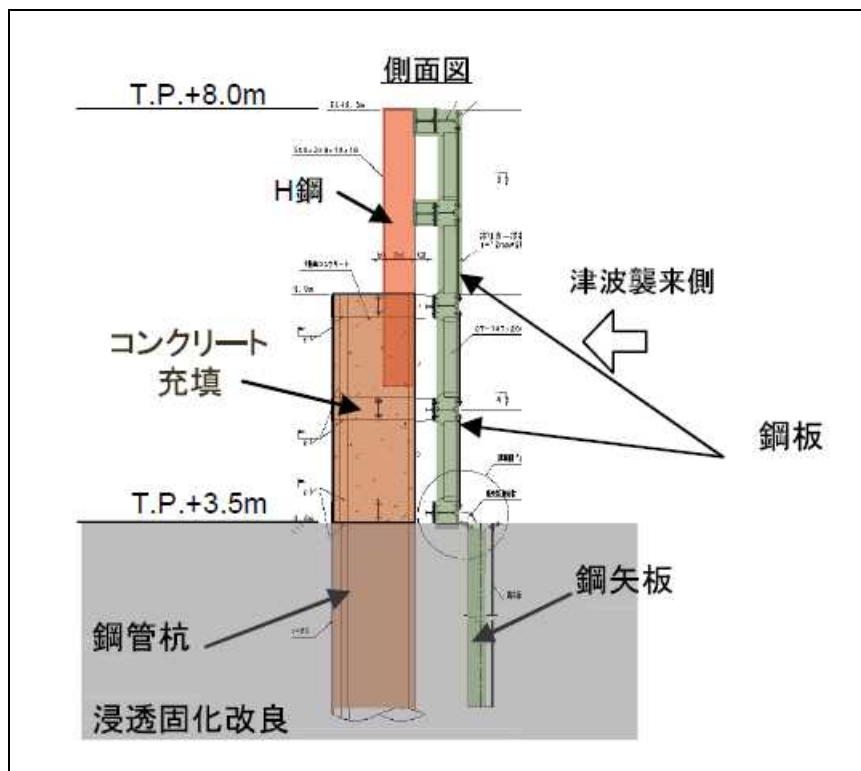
杭基礎形式部断面図 (関西電力 高浜 1, 2 号炉)
